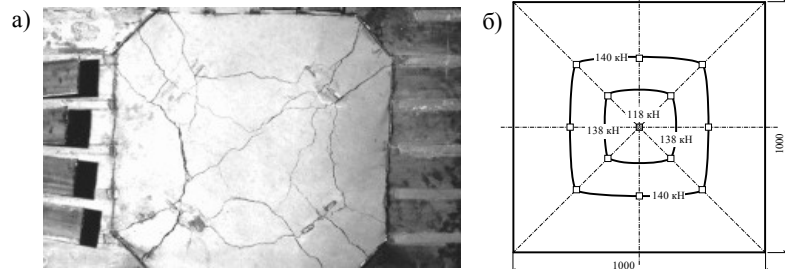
Схема трещинообразования в растянутой зоне бетона плиты П1 после вскрытия стального листа (а) и развитие пластических свойств в листовой арматуре (б).
